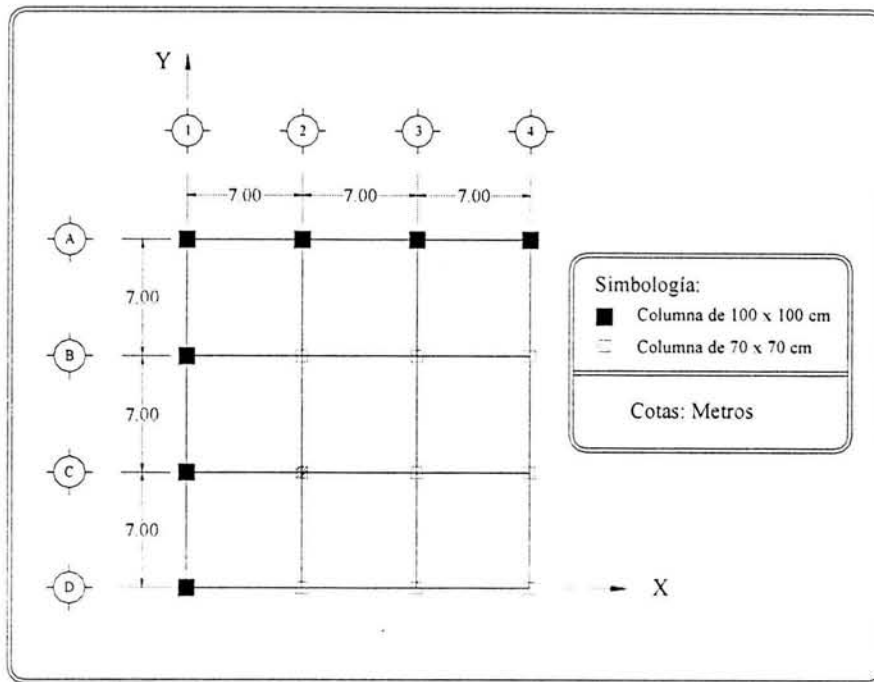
Vista en planta de un edificio de 8 niveles con asimetría en rigideces
